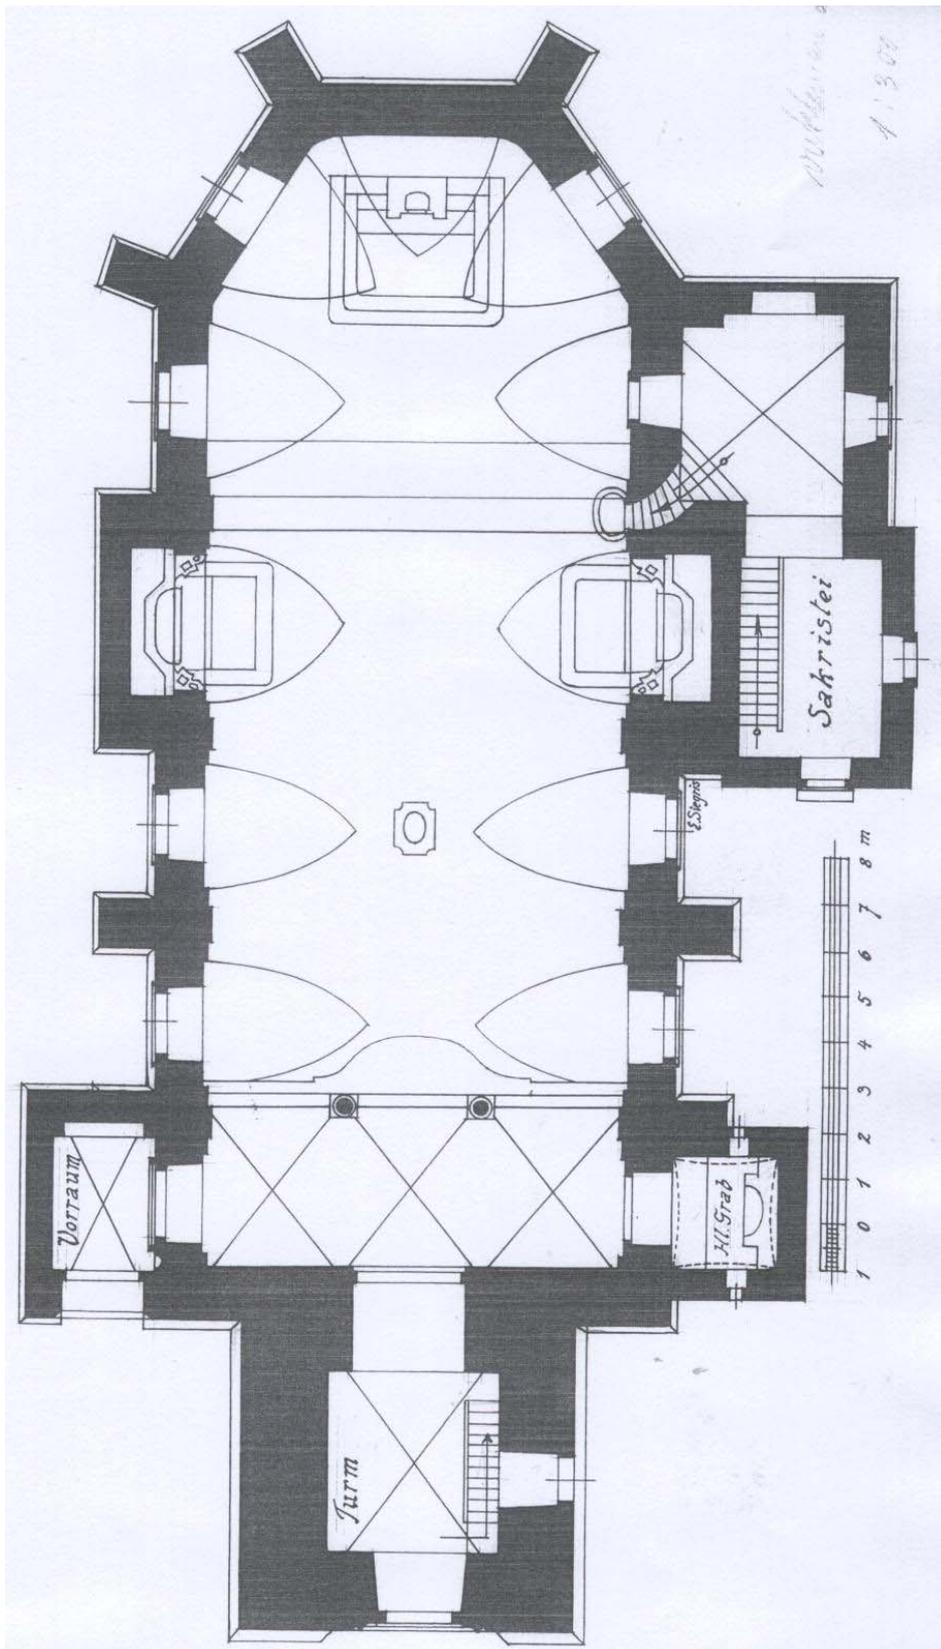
, Grundriss 3, Breitenbrunn, Pfarrkirche³²³
